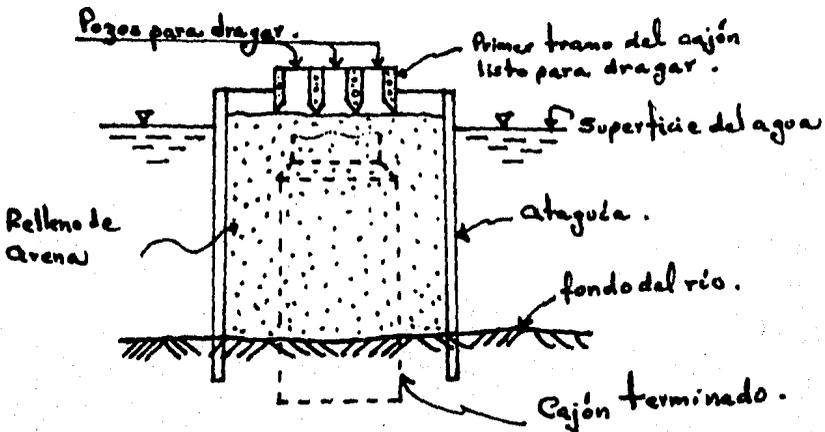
Sección transversal de cajones abiertos, Construcción en islas de arena.
